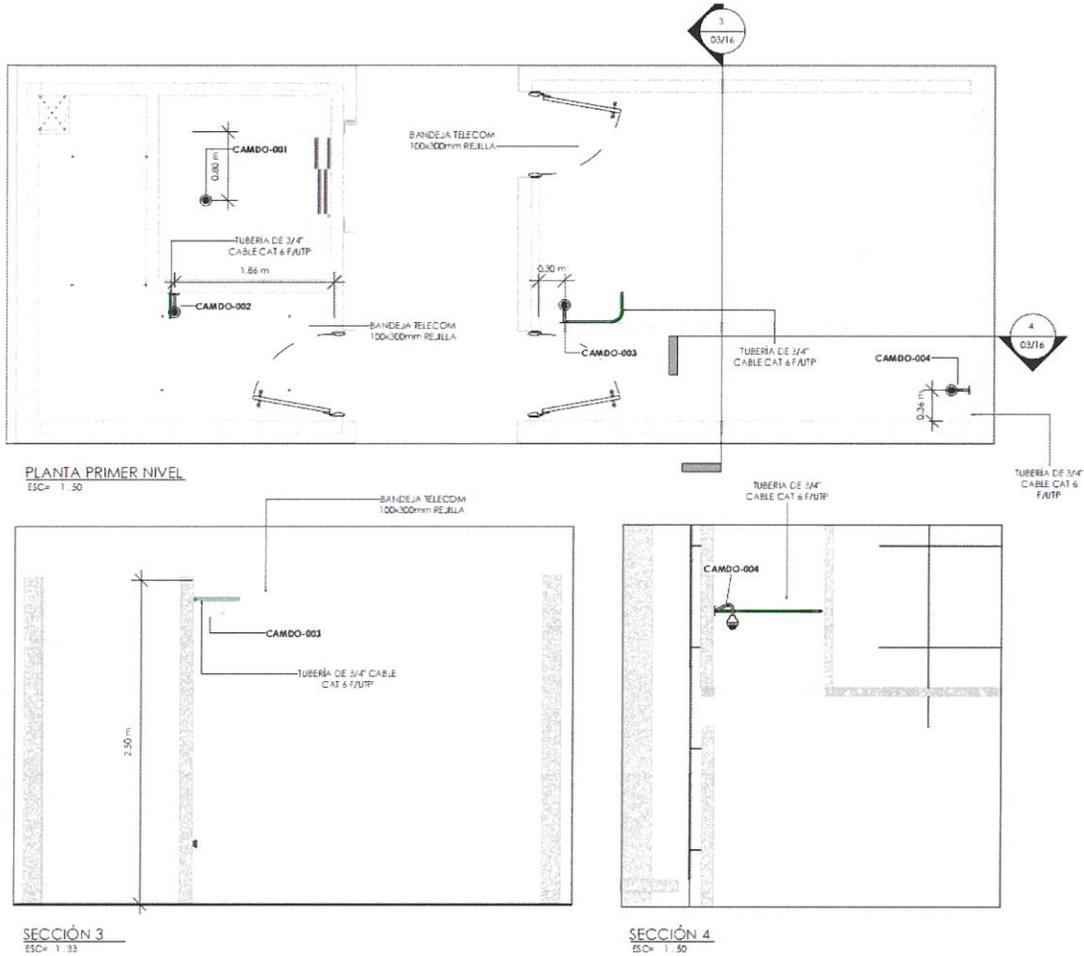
Elevación y Planta de Estación Típica con Ubicación de Equipos de CCTV
